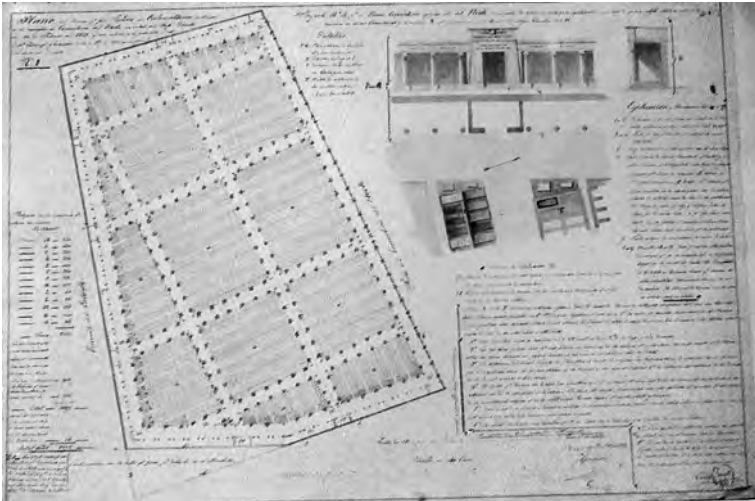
Carlo Zucchi. Plano del terreno que fue jardín de aclimatación destinado a ser agregado al Cementerio del Norte y proyecto con variante en la traza que incorpora pórtico perimetral. Planta general con detalle de columnata y disposición de las tumbas, 5 de febrero de 1830. Fuente: Aliata y Lacasa (1998) lámina 15: 113.
